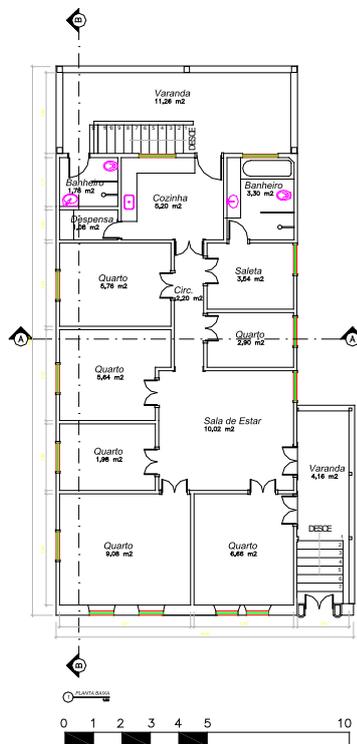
Planta pavimento térreo - Casa Nadir Dutra Lopes
